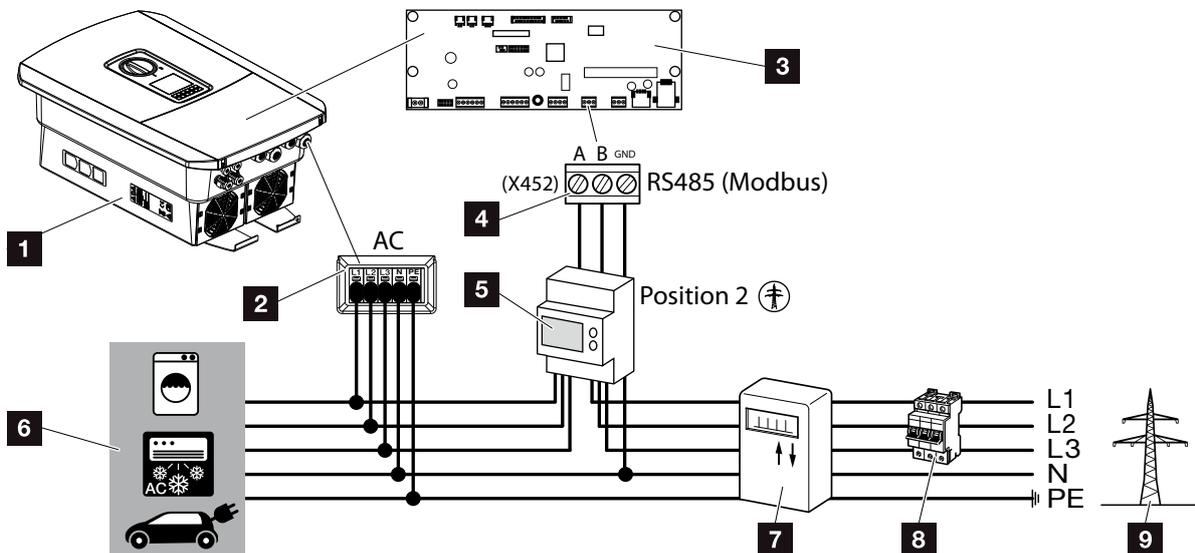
Collegamento contatore di energia – Collegamento lato rete (posizione 2)
